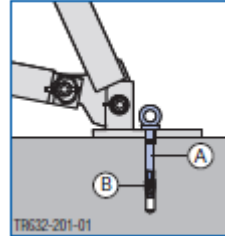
kotvení univerzálního prvku; zdroj [31]
